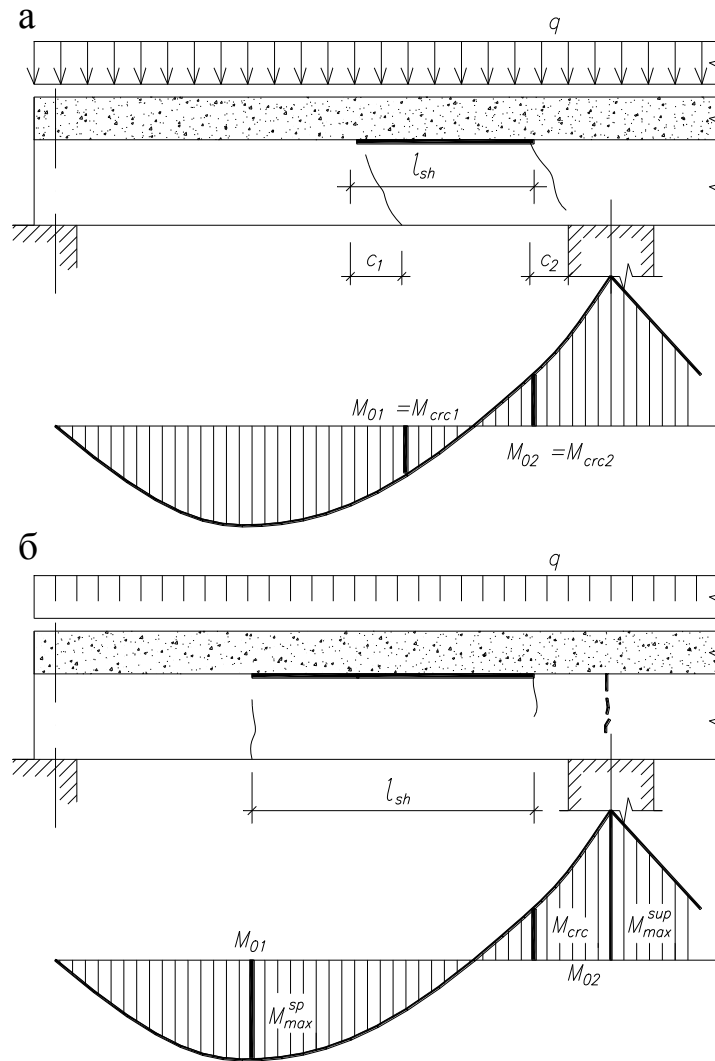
Схема для определения расчетной длины контактного шва у неразрезной опоры:
